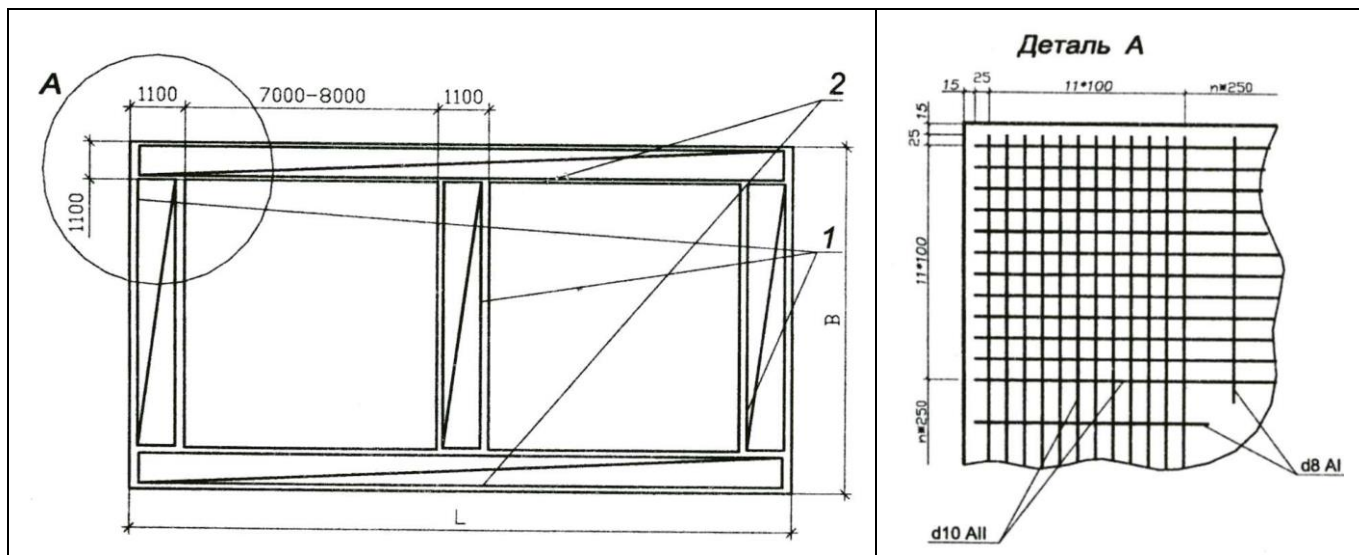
Армирование «рамного контура» при устройстве гидроизоляции выравнивающего слоя из бетона на напрягаемом цементе
